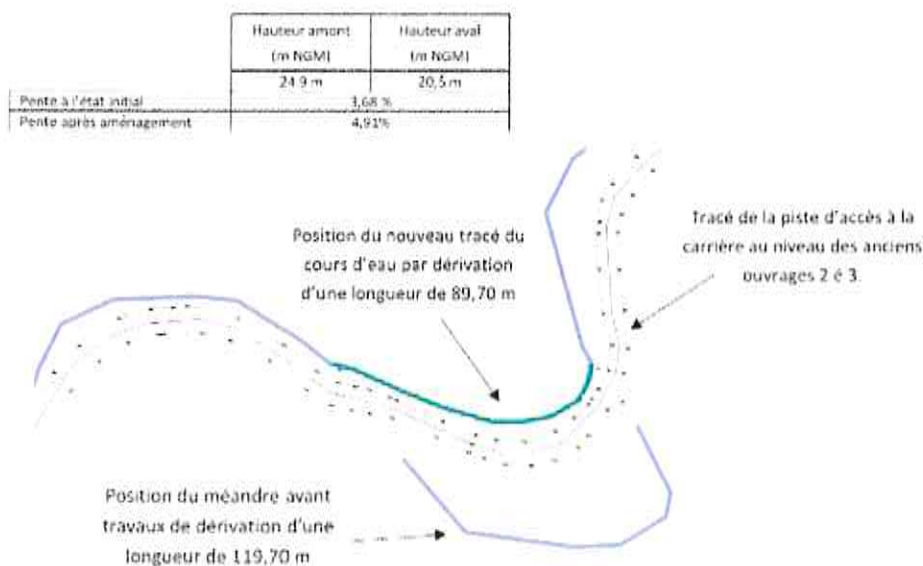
Pentes, longueurs, plan de l'ancien méandre (ex ouvrages n°2 & 3) et plan de la dérivation créée.
